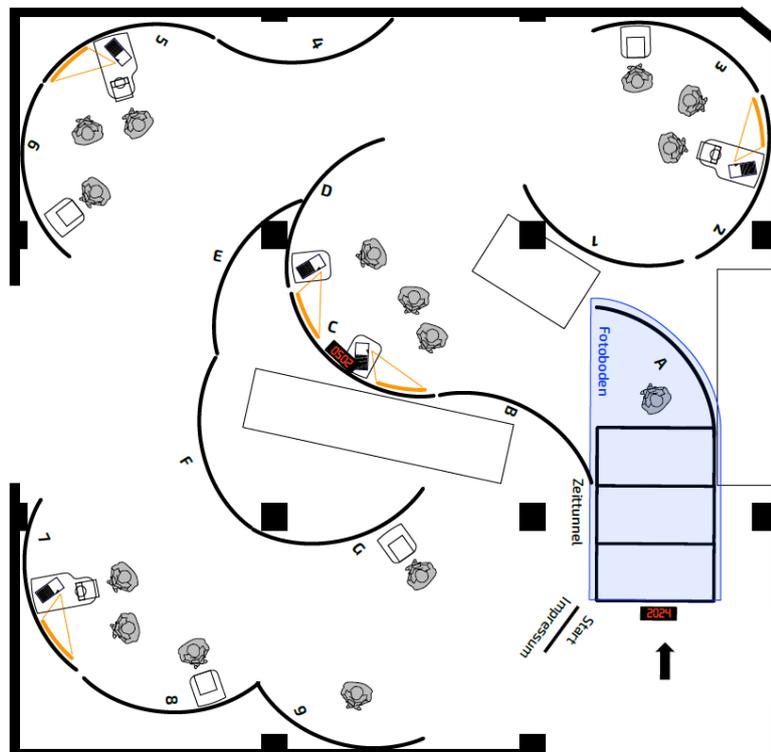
Grundriss Futur II im Kultur-Schloss Theuern © hof3
